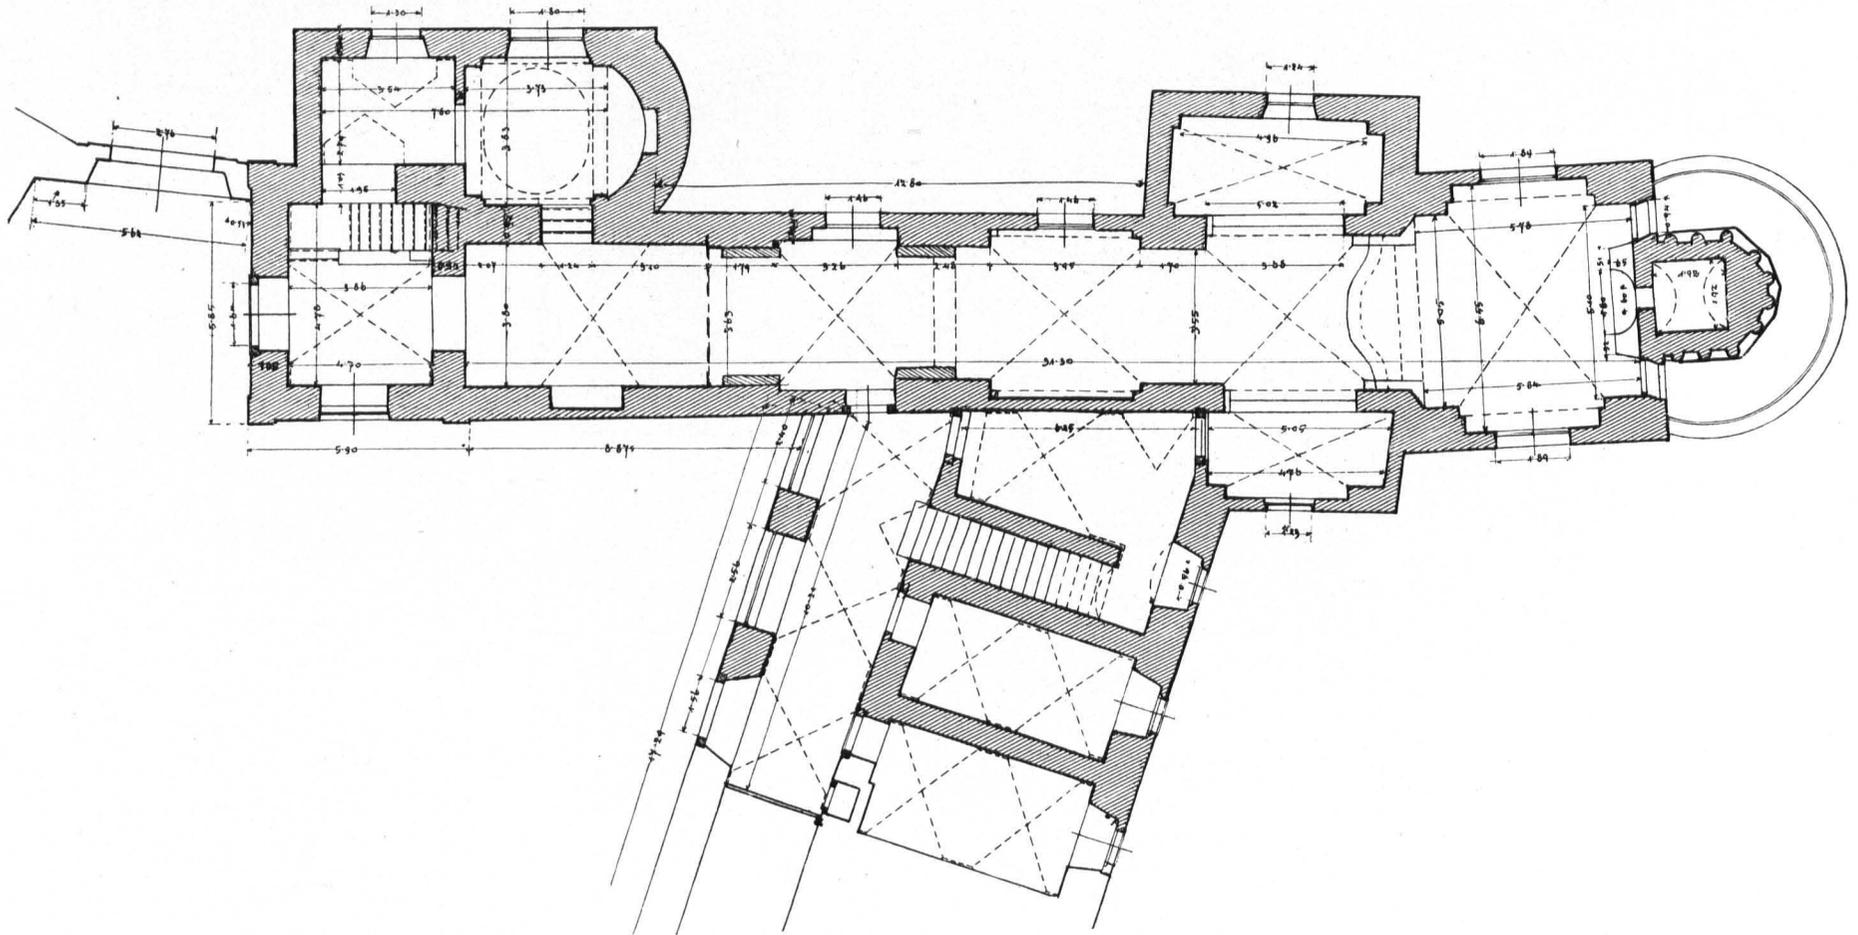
Schönbüchel, Grundriß der Kirche (S. 423)
